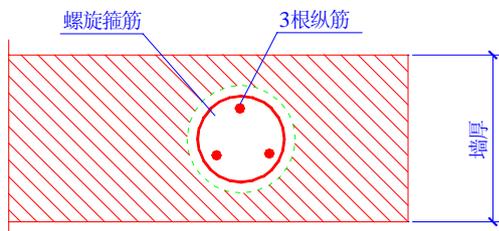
墙体两端构造边缘构件中的纵向受力钢筋
